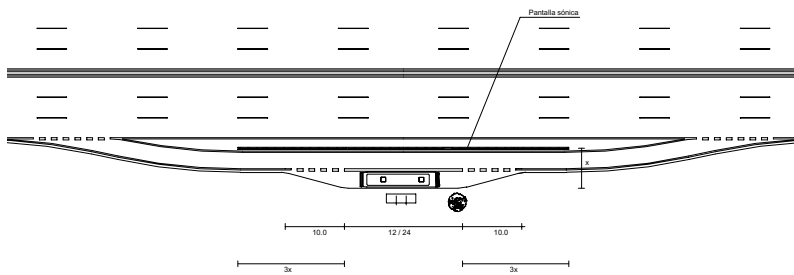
PROTECCIÓN ACÚSTICA DE PARADAS DE AUTOBÚS SOBRE AUTOPISTAS O AUTOVÍAS
